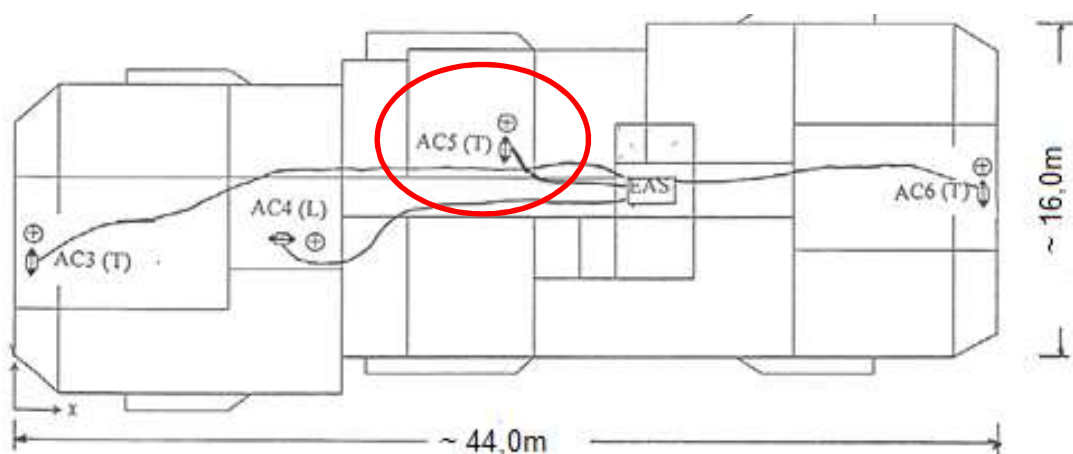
Plano de instrumentação – vista em planta/ topo. Localização e direção dos acelerômetros AC3 ao AC6, (BATTISTA et al, 1999/2000).
